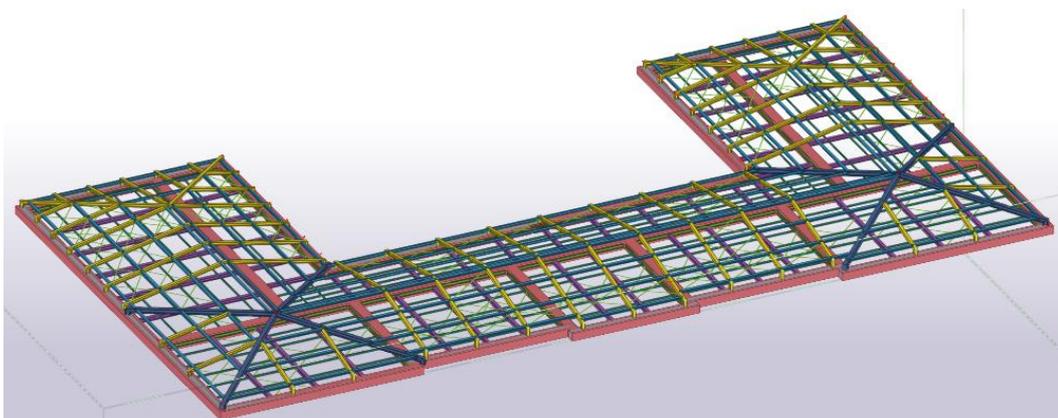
Cordoli in muratura armata e graticcio di travi per la formazione del piano rigido all'ultima elevazione
